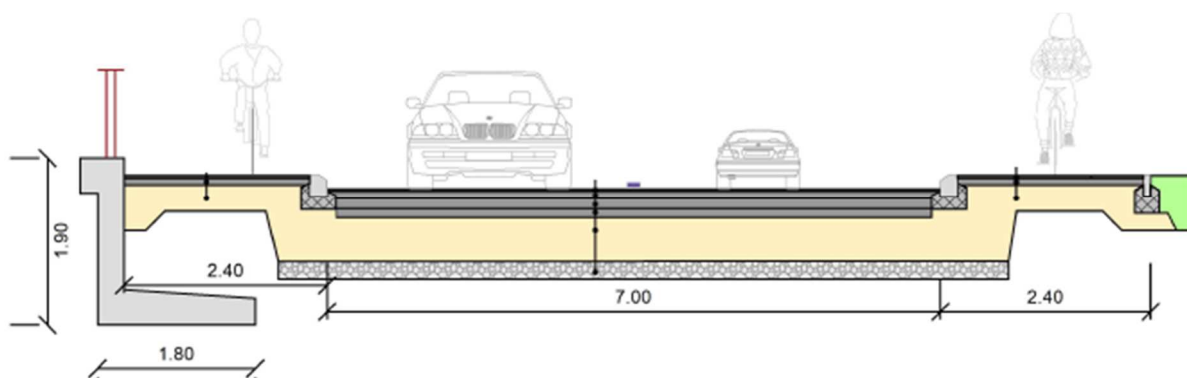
Profil type de la requalification de la RC 1 avec pistes cyclables et l'ouvrage de soutènement à proximité du pont sur la Dullive
